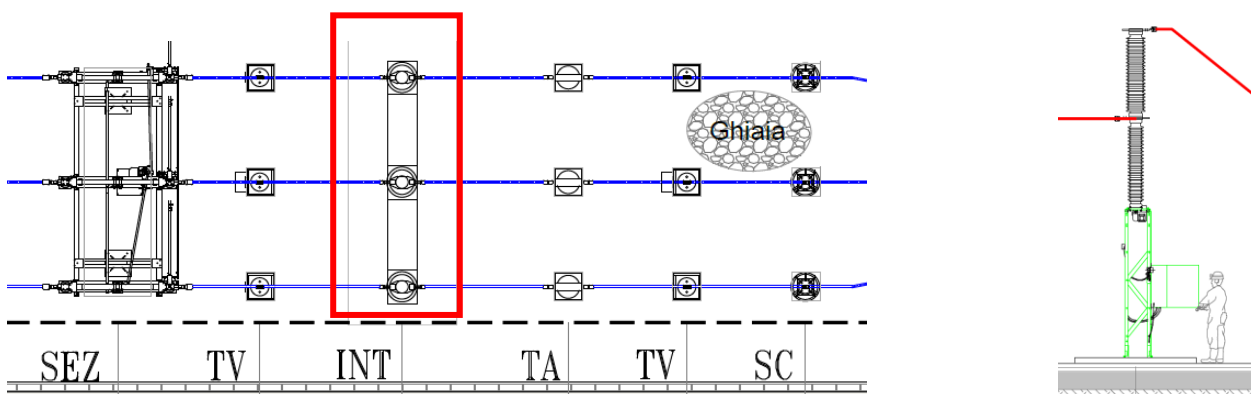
Tipico interruttore tripolare – vista prospettica e planimetrica
